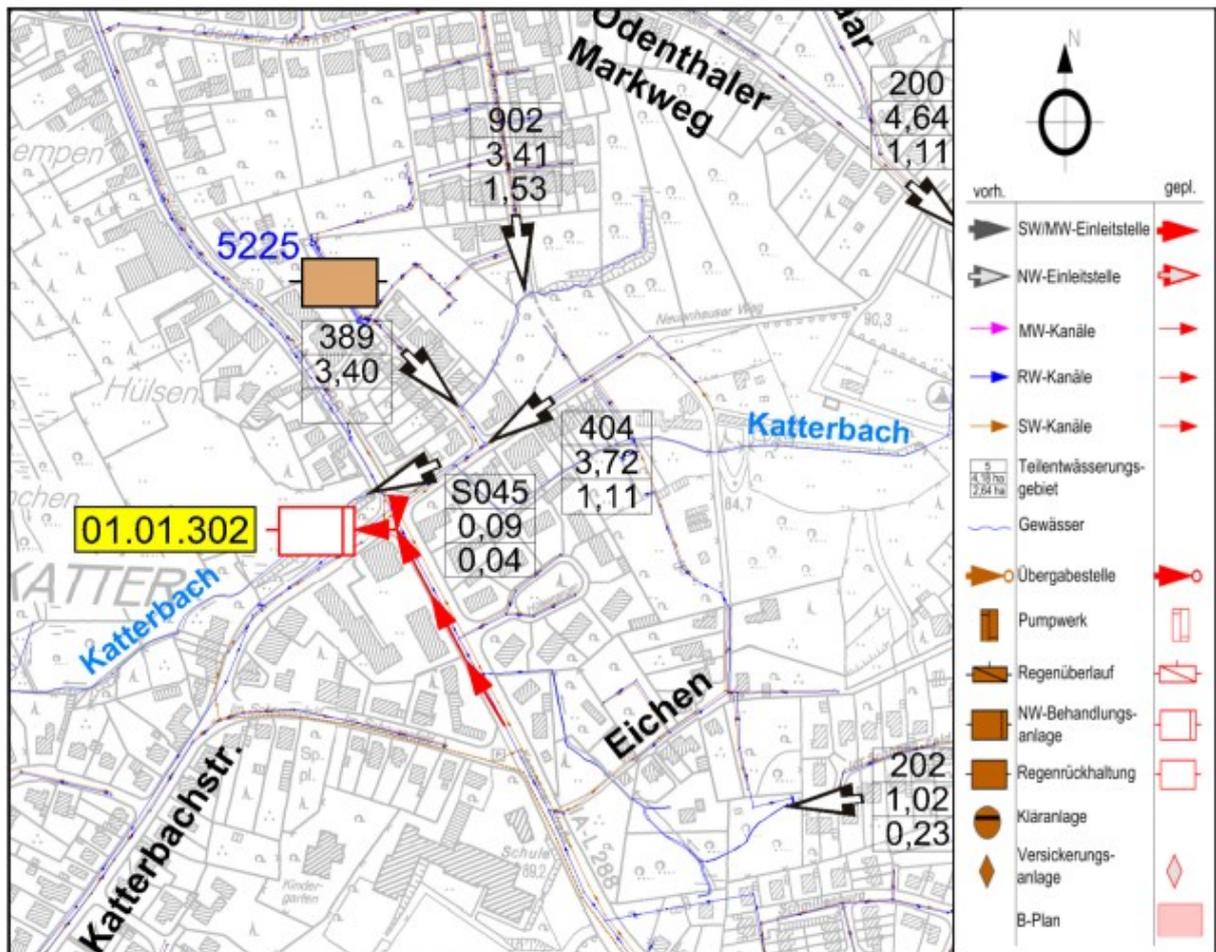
Auszug aus Lageplan (unmaßstäbliche Darstellung)
